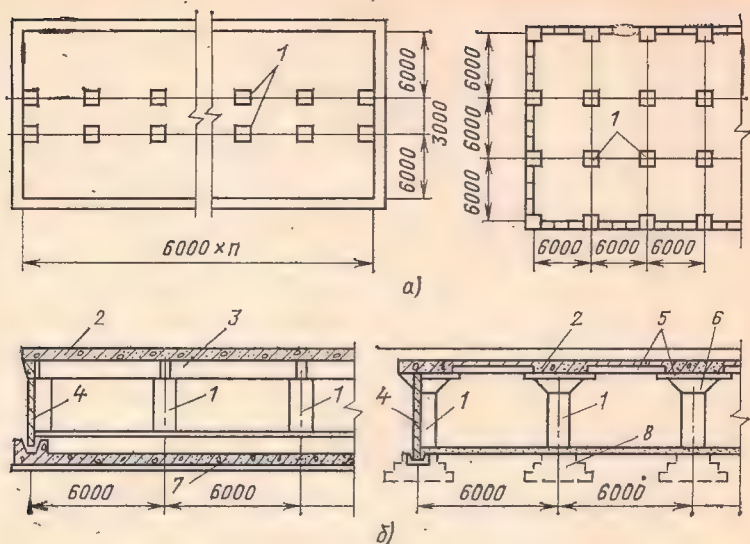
Конструктивные схемы убежищ из сборных железобетонных элементов серий У-01-01 и У-01-02:
